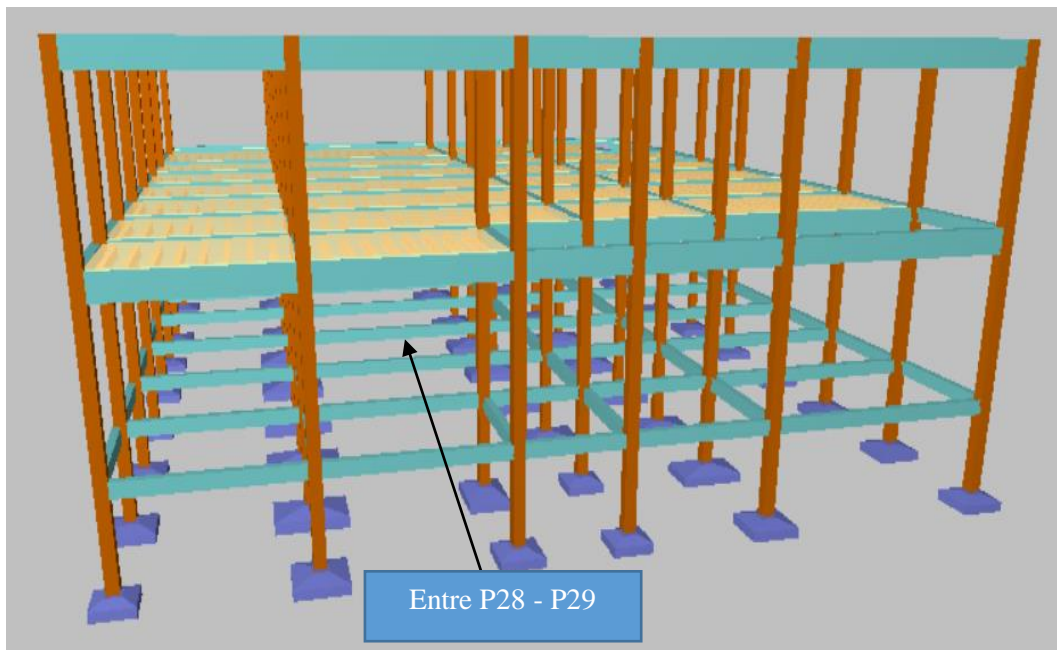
Viga más solicitada Entre las columnas P28 – P29 primera losa
